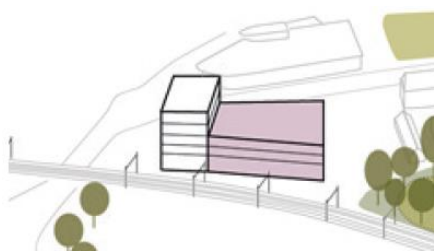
Variante 1, Ersatzneubau Sportcenter Würzenbach
